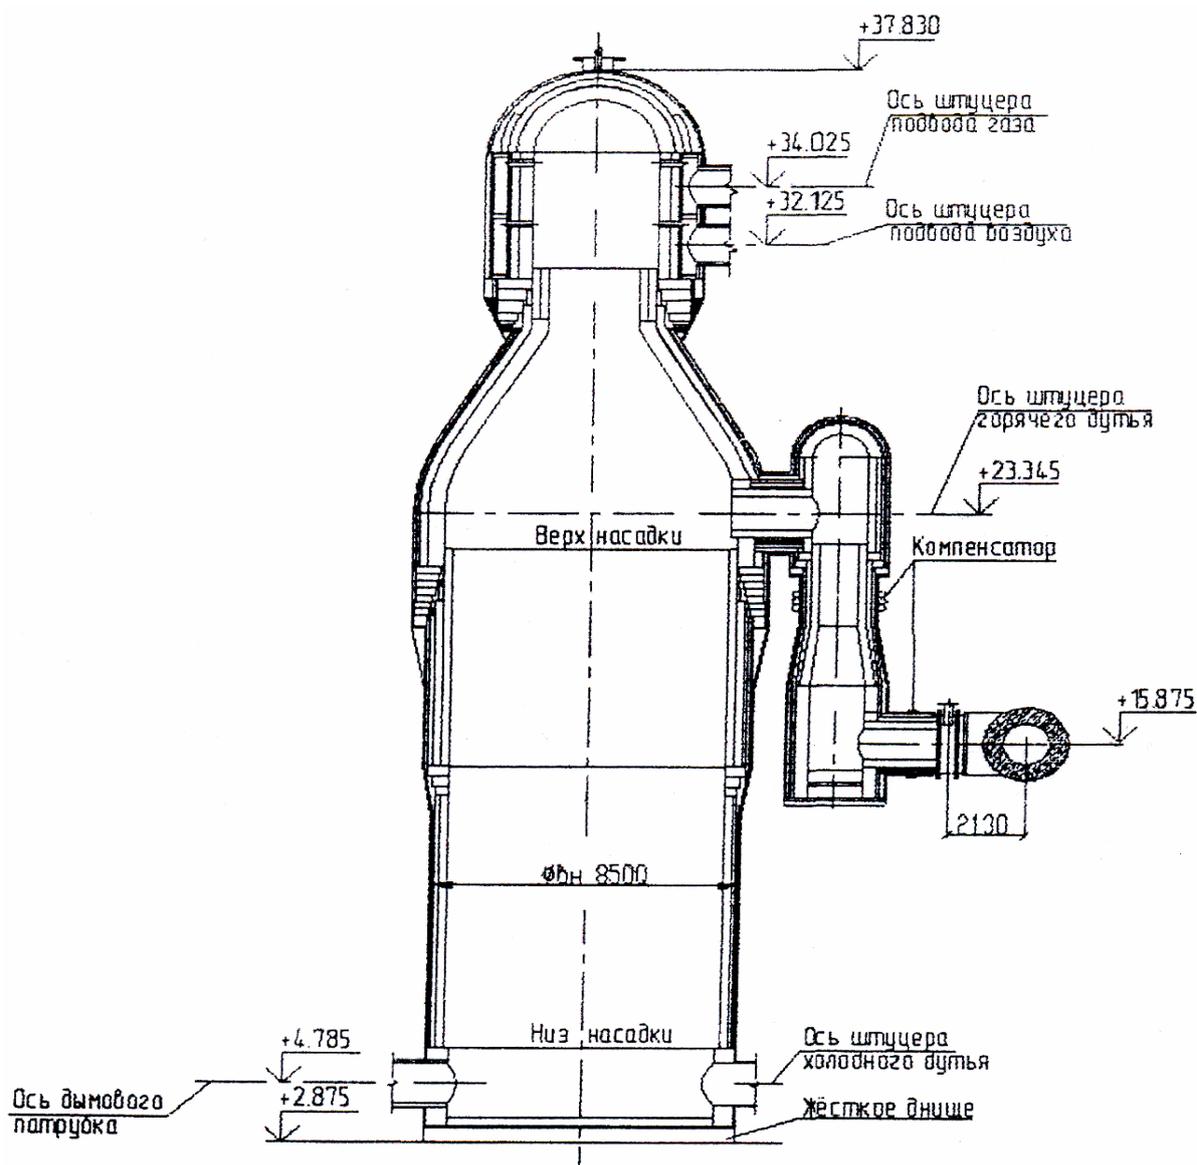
Воздухонагреватель с купольным отоплением конструкции Я.П. Калугина
